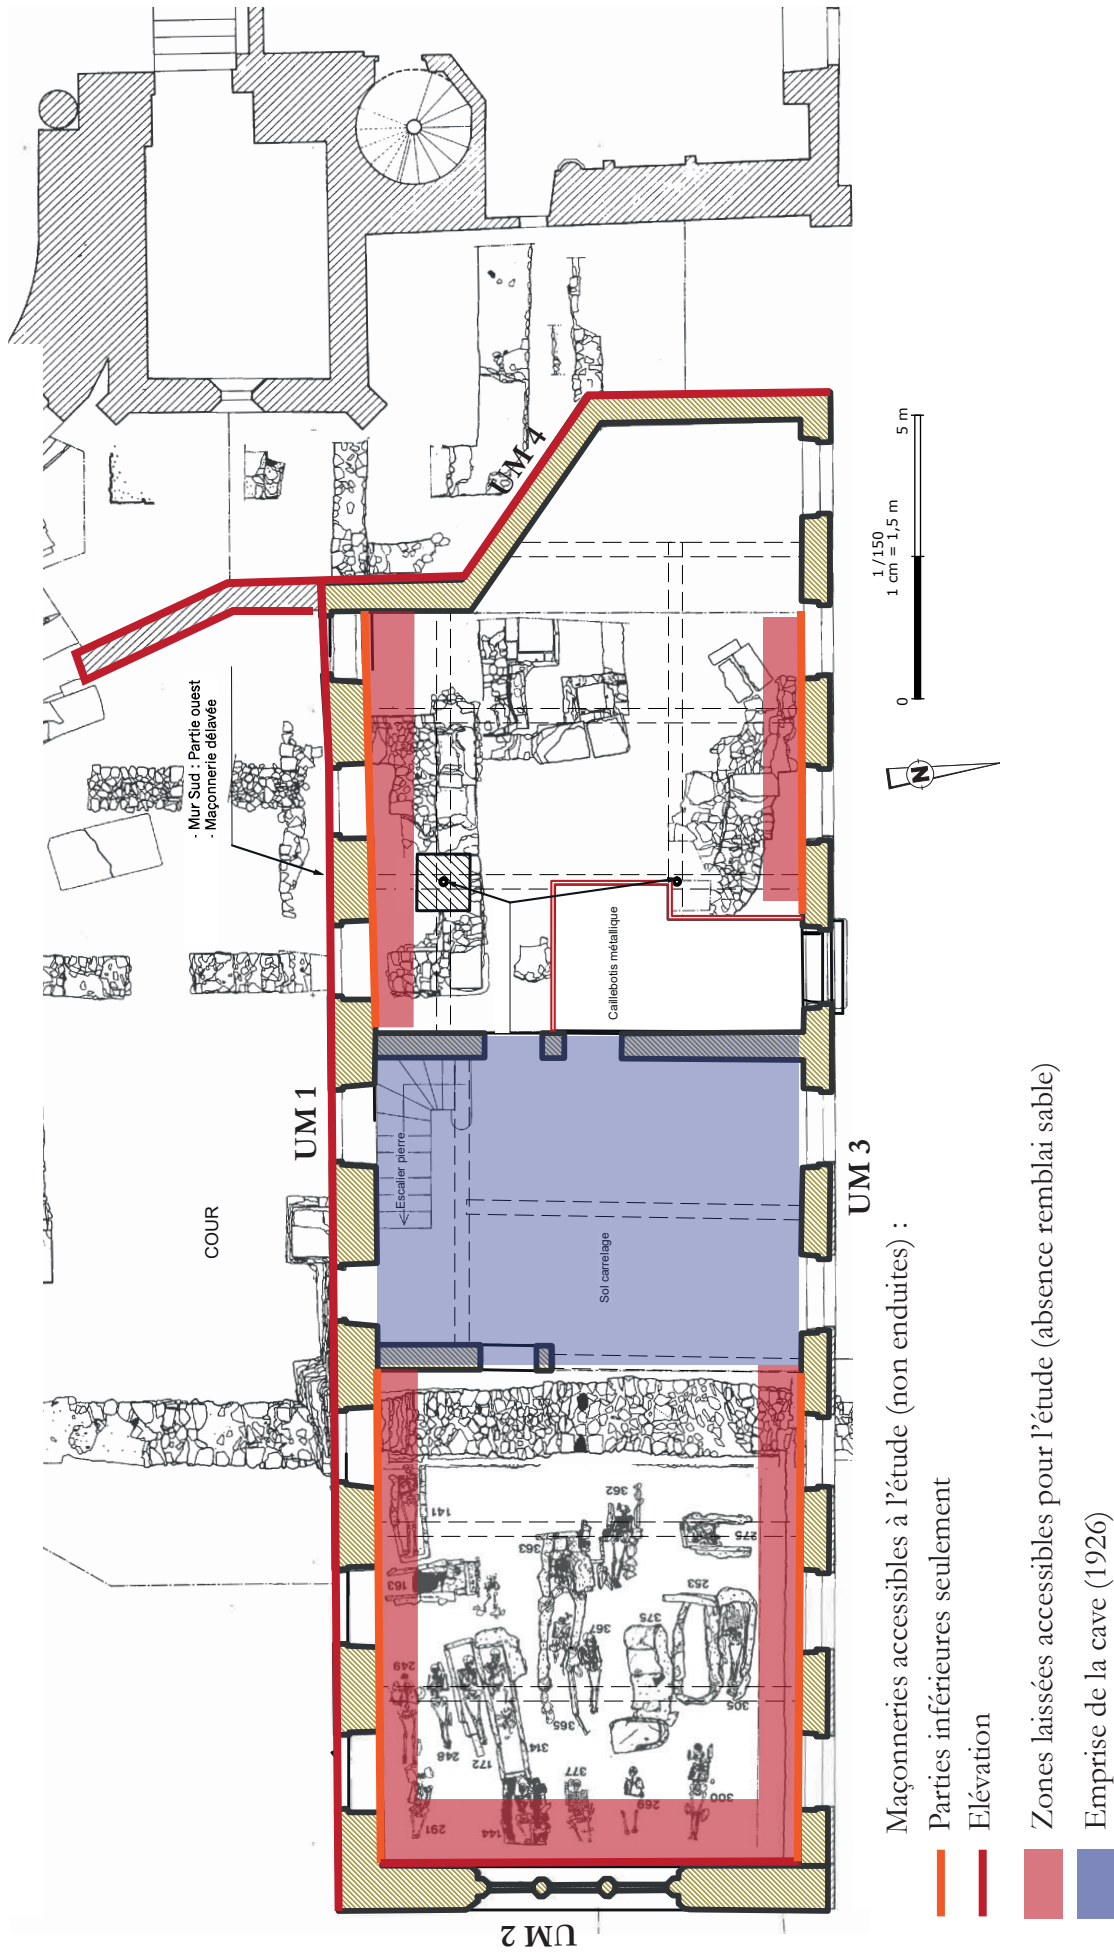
Plan de Saint-Georges et localisation des interventions archéologiques, éch. : 1/150^e; Fond de plan : Alep Architectes / Jannet-Vallat 1987, plan d'ensemble VIII/01 ; DAO : Quentin Rochet.
